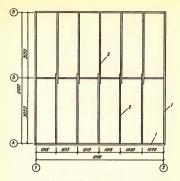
План укладки балок цокольного перекрытия: 1 — брусья наружных стен; 2 — балки перекрытия
